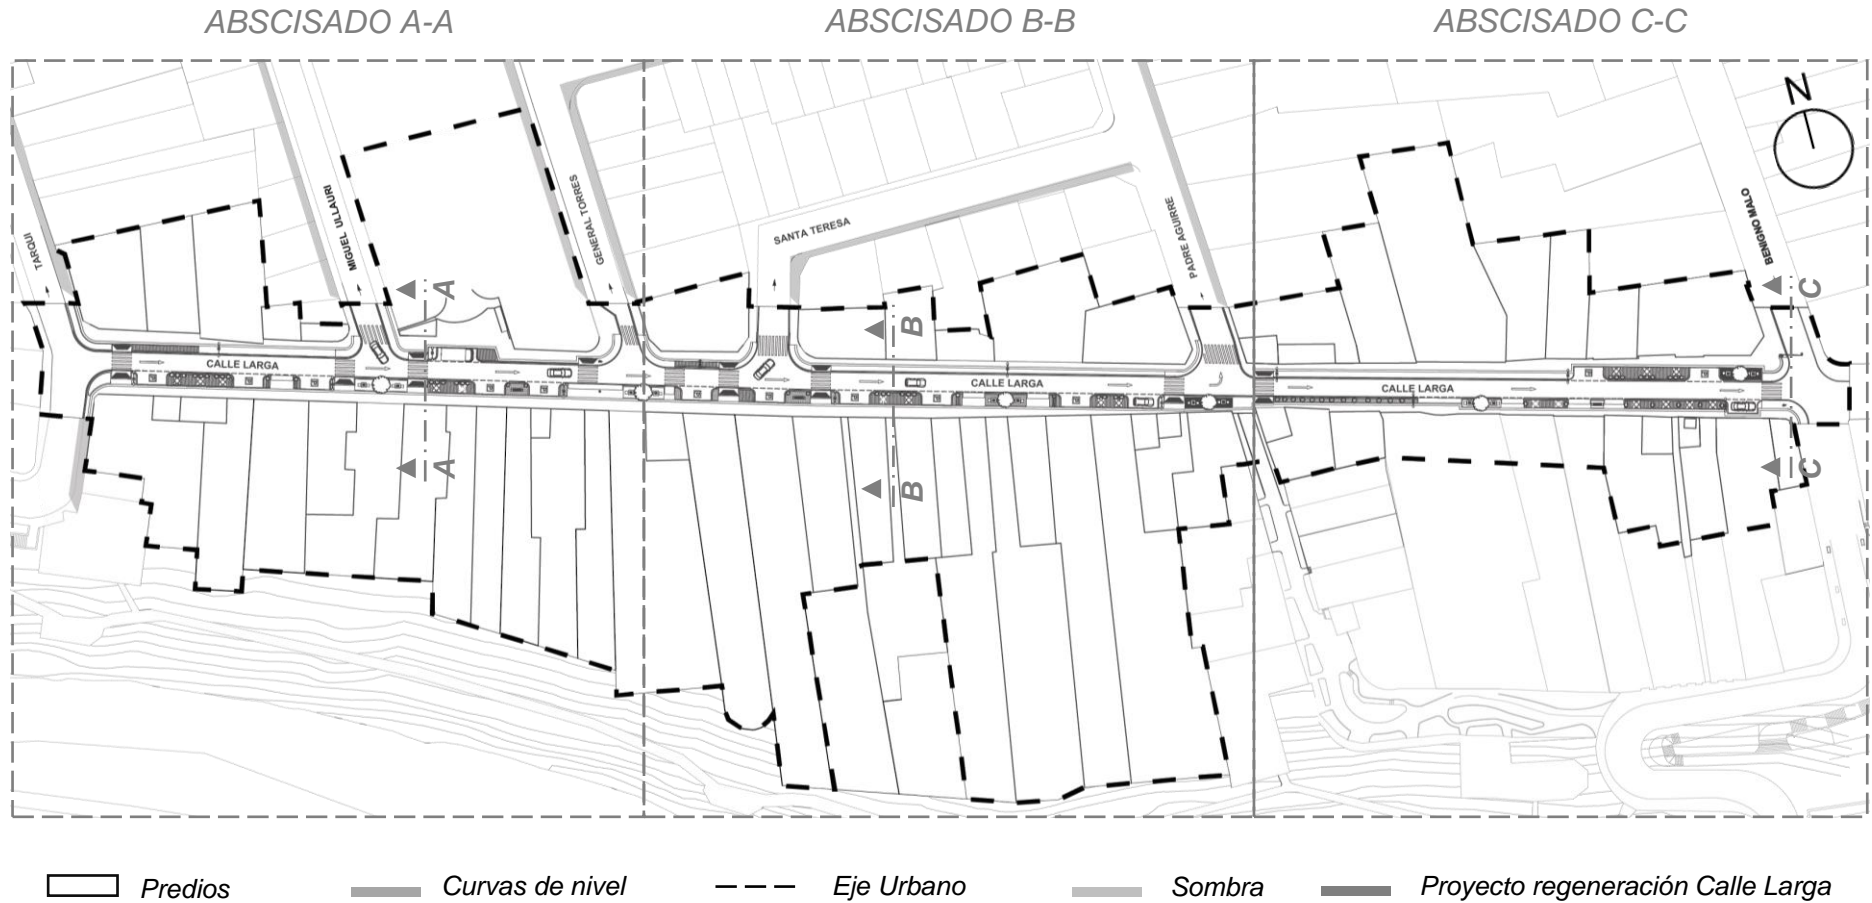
Emplazamiento de proyecto urbano arquitectónico
